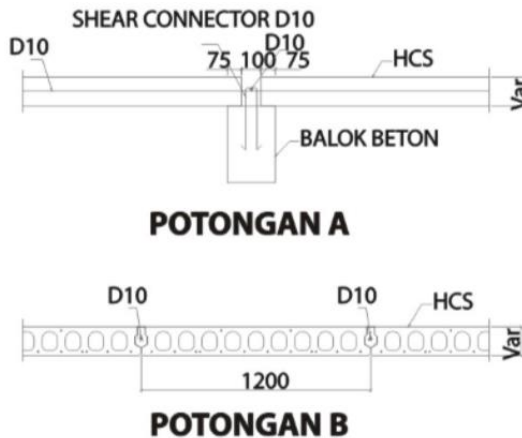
Peletakan Pelat Precast Hollow Core Slab
